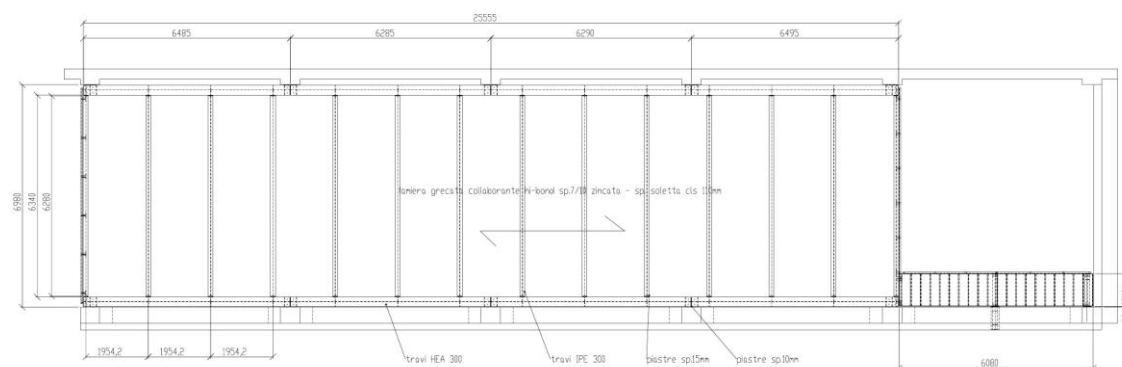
Particolare di A.2012.a.sa.T02 - Progetto della struttura - Pianta strutture principali
